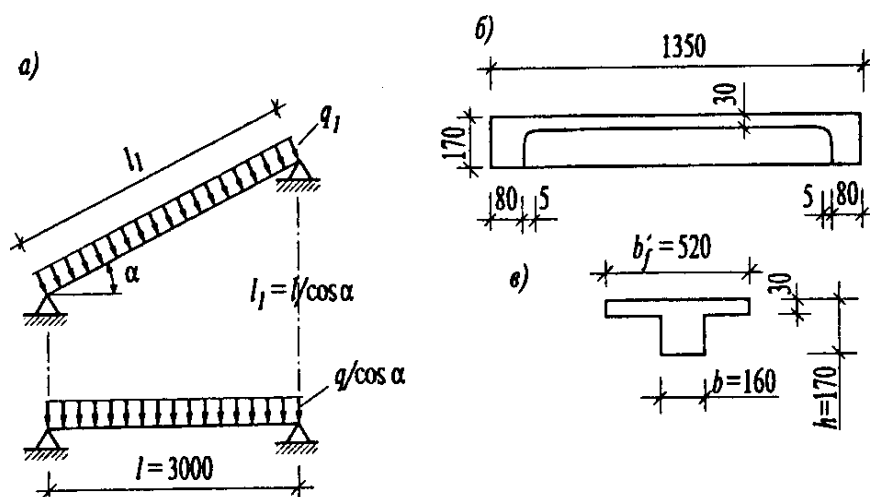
Расчетная схема, реальное и приведенное поперечные сечения
